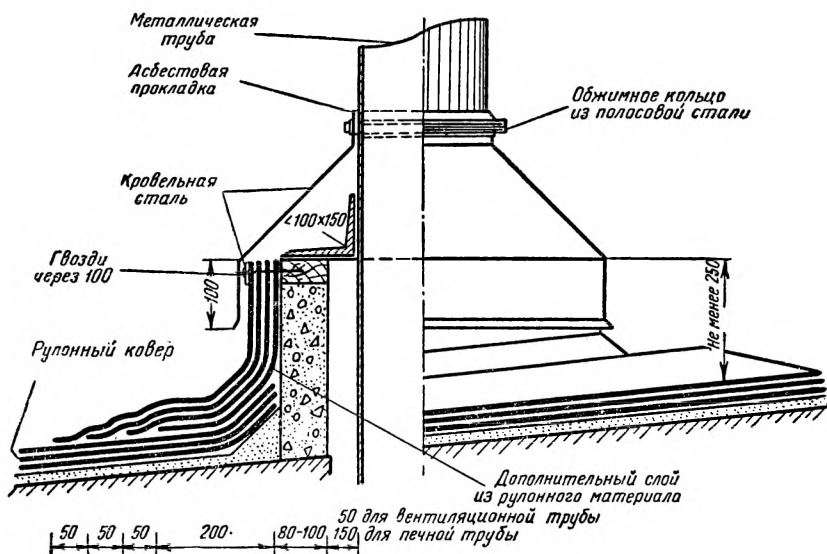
Примыкание рулонного ковра к вентиляционной трубе с бетонной горловиной
